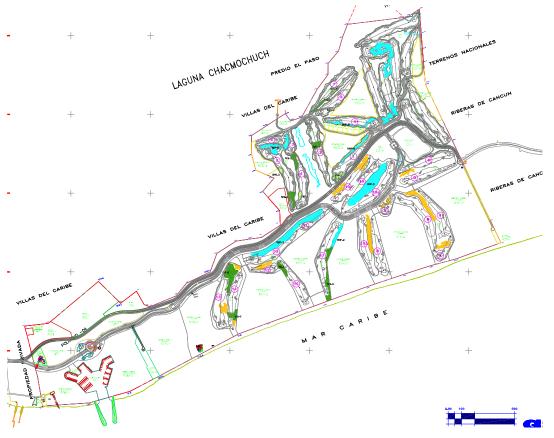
Plan Maestro del proyecto Playa Mujeres.
